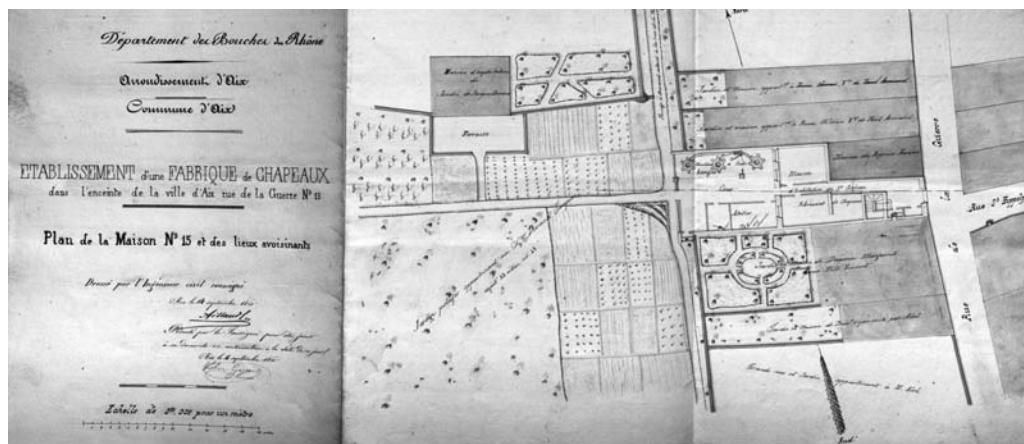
Plan de la fabrique de chapeaux à Aix, demande d'autorisation, 1860, AD BDR, 5M
